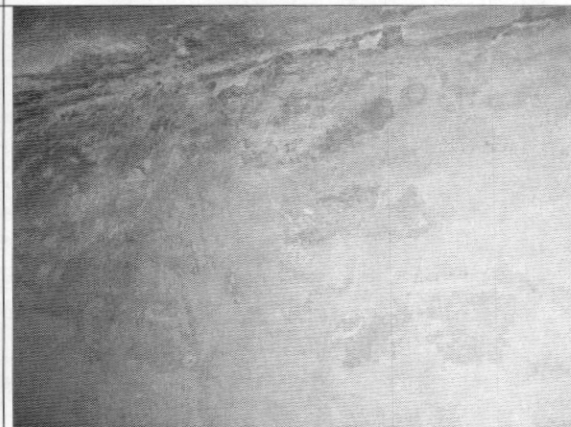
Fisura en muro perpendicular a la fachada
